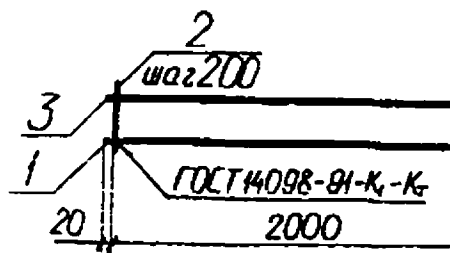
Обозначение сварного шва по ГОСТ 2.312-72
